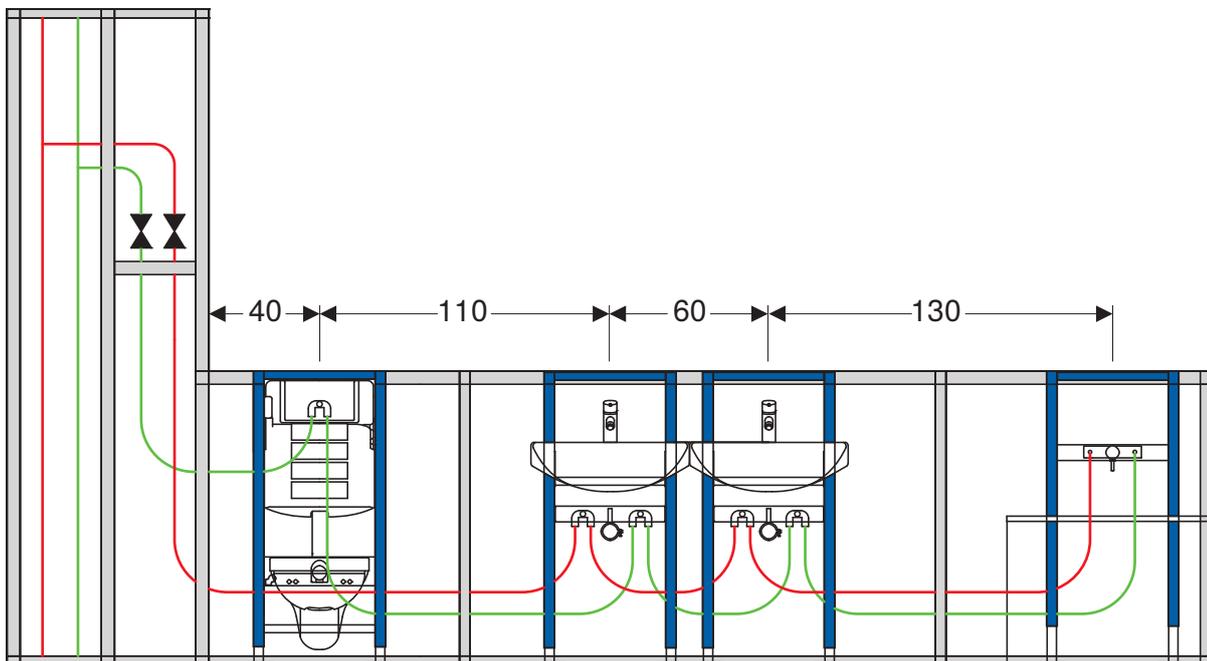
Durchgeschleifte Stockwerksinstallation mit Doppelanschlusswinkel
